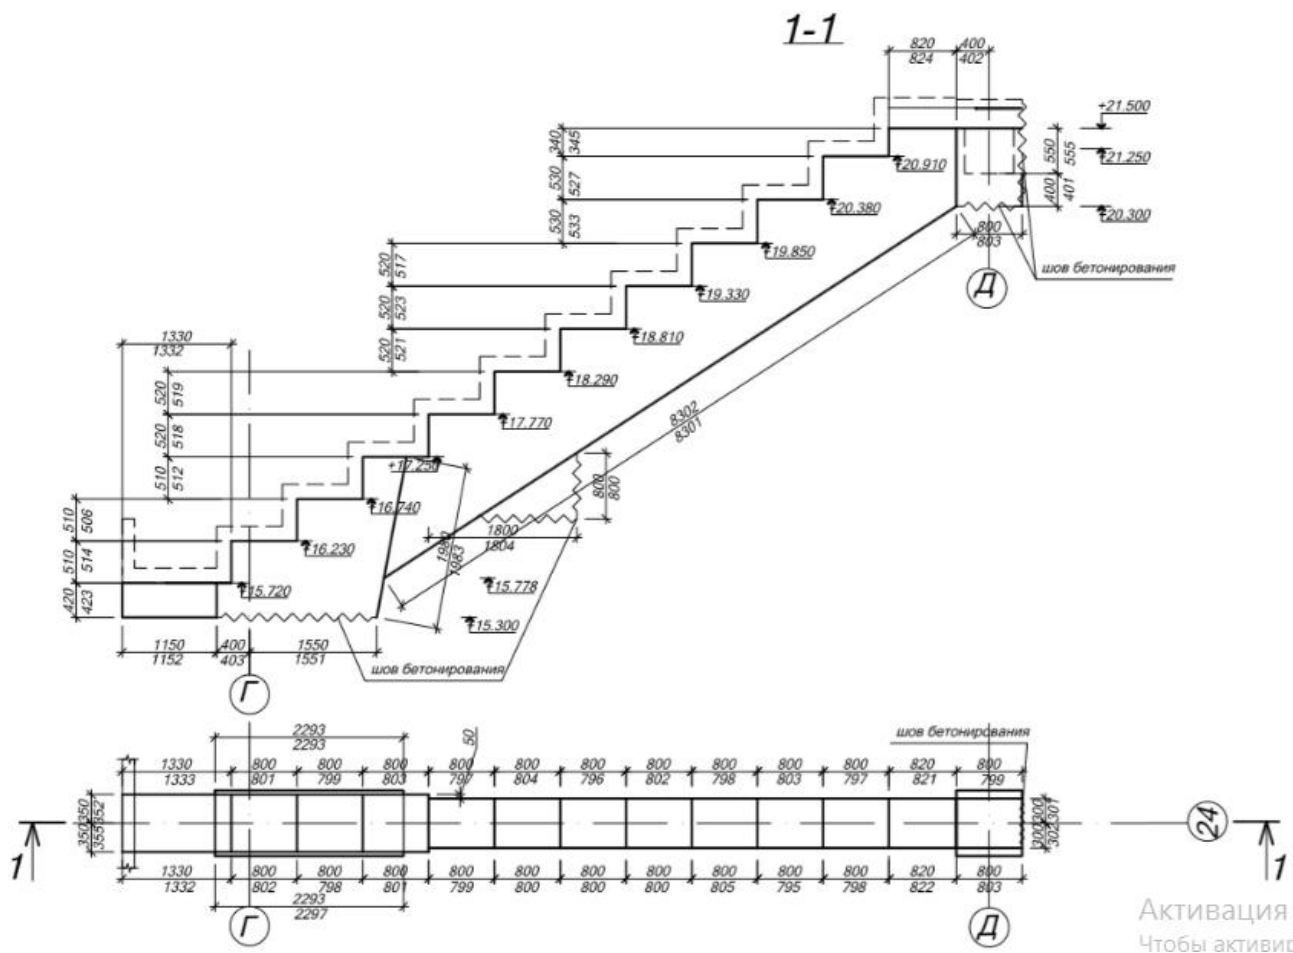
Фрагмент исполнительной съемки бетонирования трибунной балки
